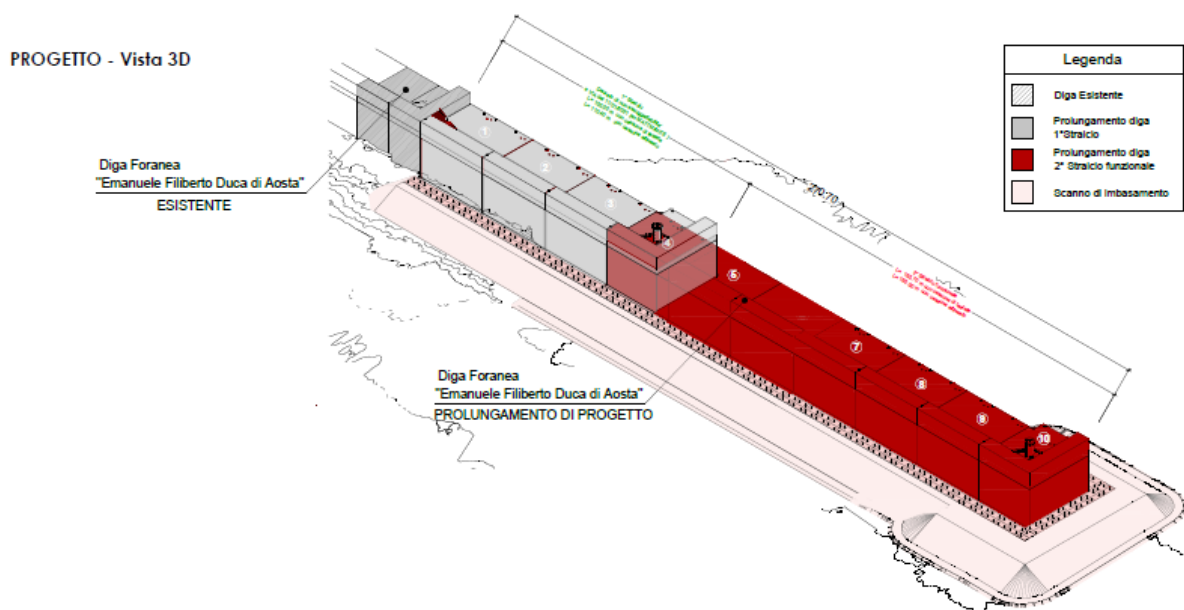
Prolungamento della diga foranea Duca d'Aosta I° e II° stralcio - Vista assometrica
